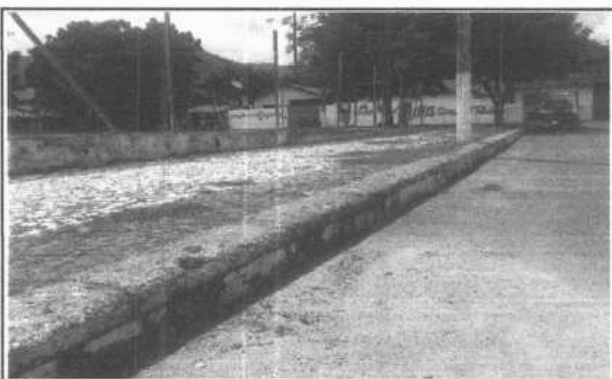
DETALHE MEIO - FIO EXISTENTE
